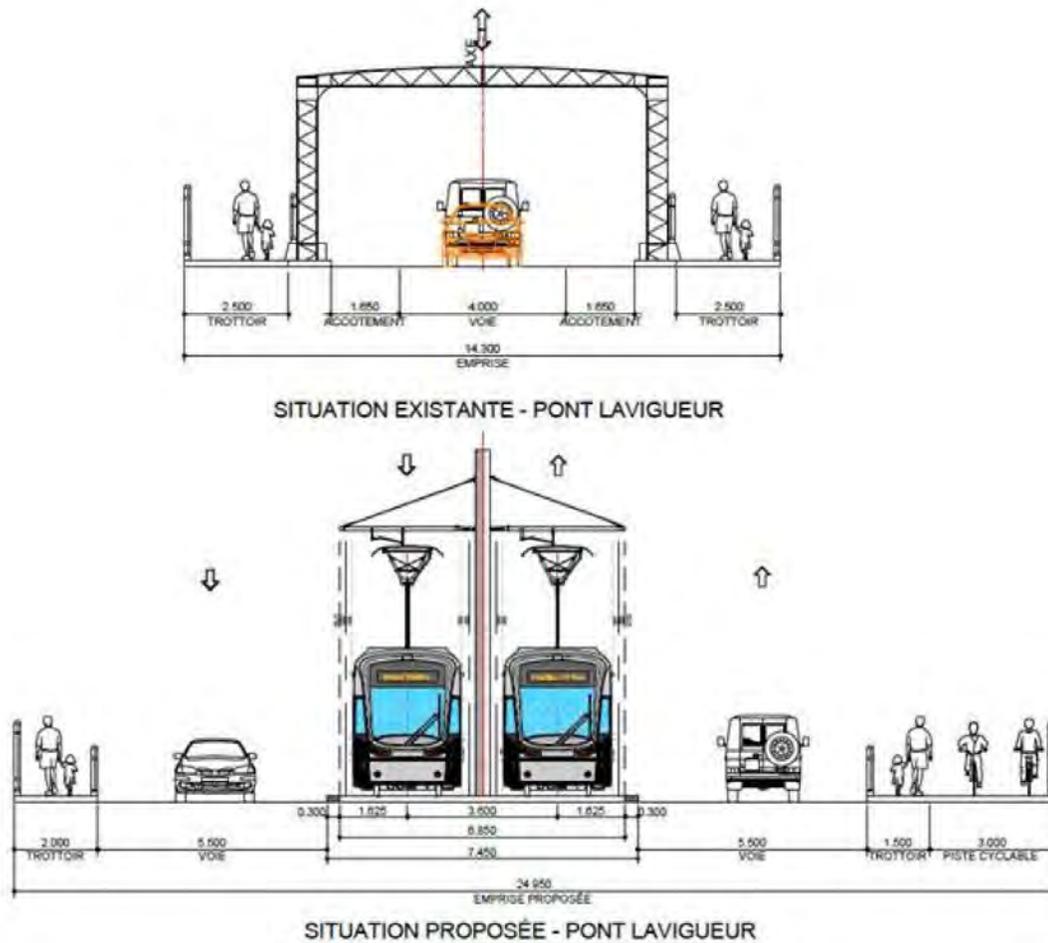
Coupes types des situations existante et proposée pour le pont Laviguer
